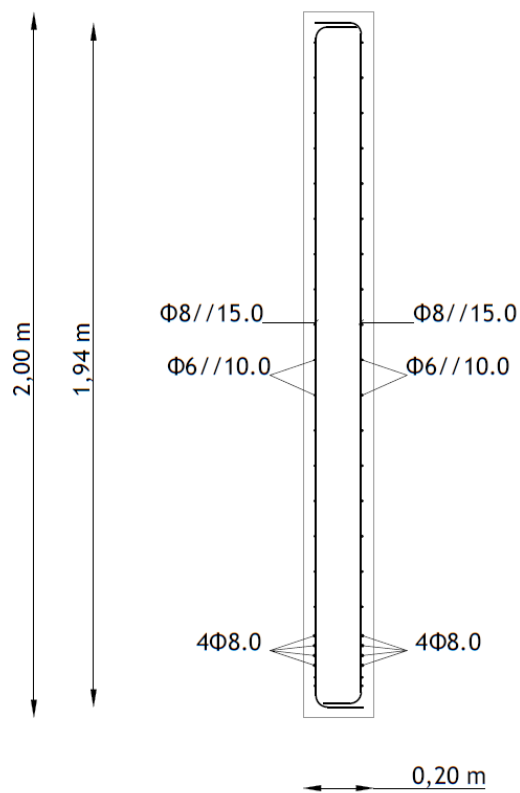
Pormenorização de armaduras relativas ao corte transversal no meio vão da viga parede.
